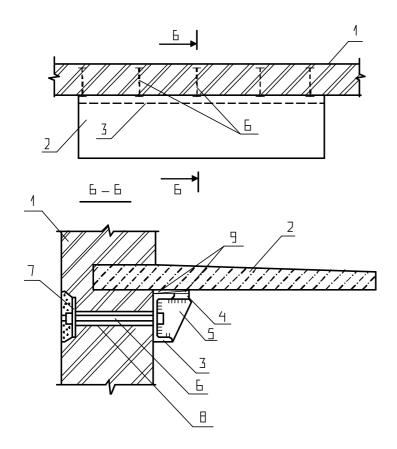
Усиление балконной плиты путем подведения металлических опорных столиков 1 — стена; 2 — балконная плита; 3 — опорный столик из швеллера; 4 — пластина опорного столика; 5 — ребро жесткости; 6 — анкерные болты; 7 — пластина-шайба; 8 — отверстие в стене (после установки болтов заполняется раствором); 9 — металлические пластины-клинья для включения столиков в работу.
